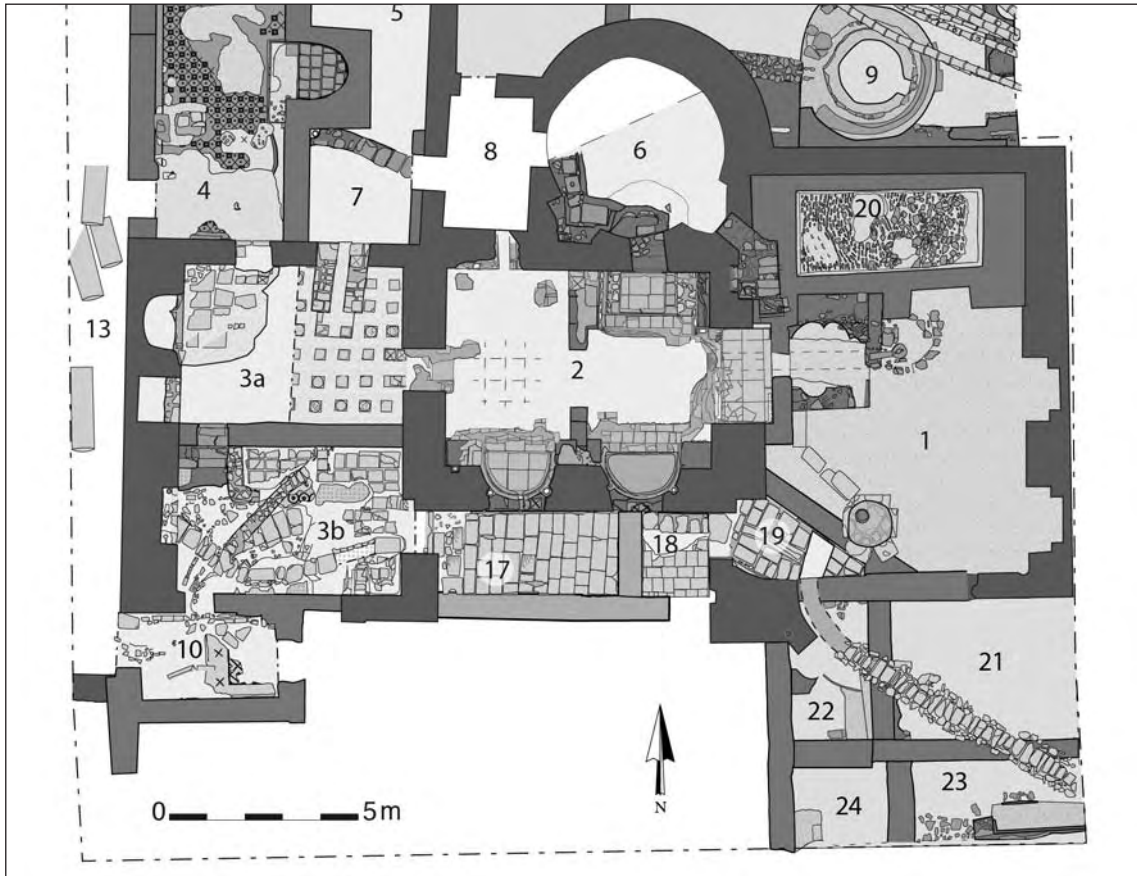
Bains du « Quartier Nord-Est » : plan des salles 2 et 6 (© CBRAAP).
